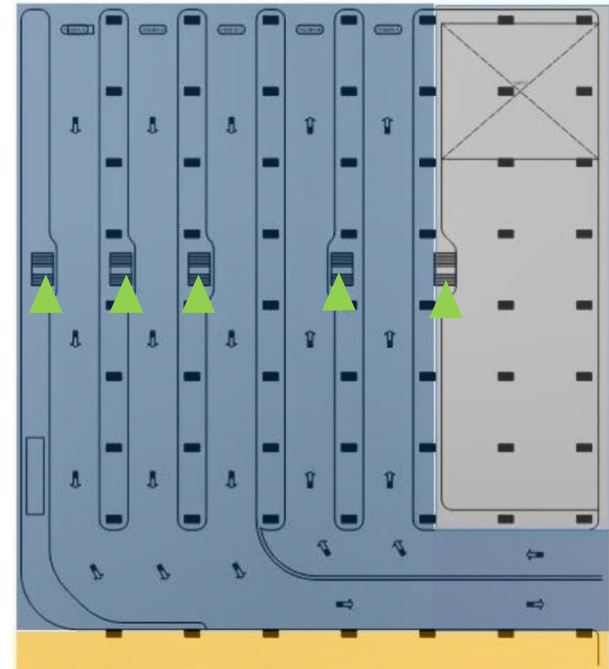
; Planta baja andenes (2014) Emmanuel Tapia Mendoza.
